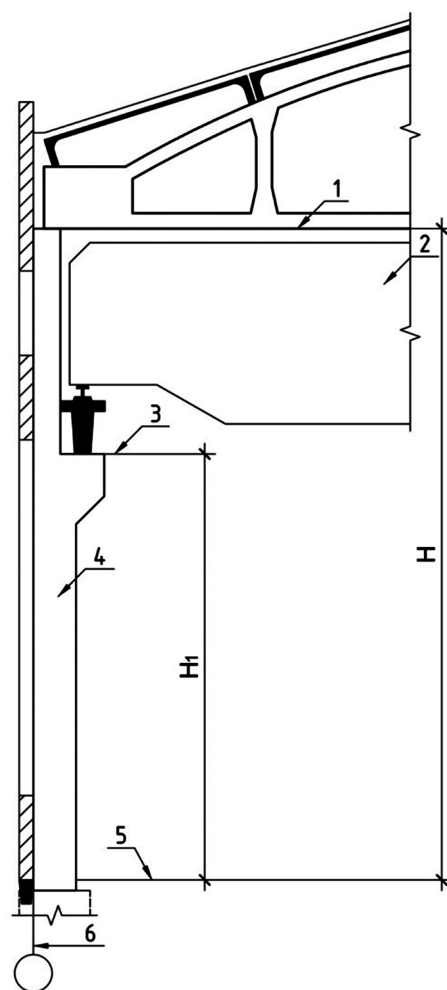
Высота зданий, оборудованных мостовыми кранами:
